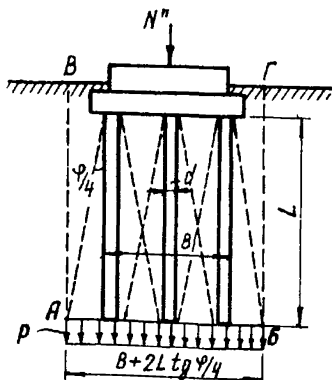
Схема к расчету осадок условного фундамента при кустовом расположении свай без уширений.
